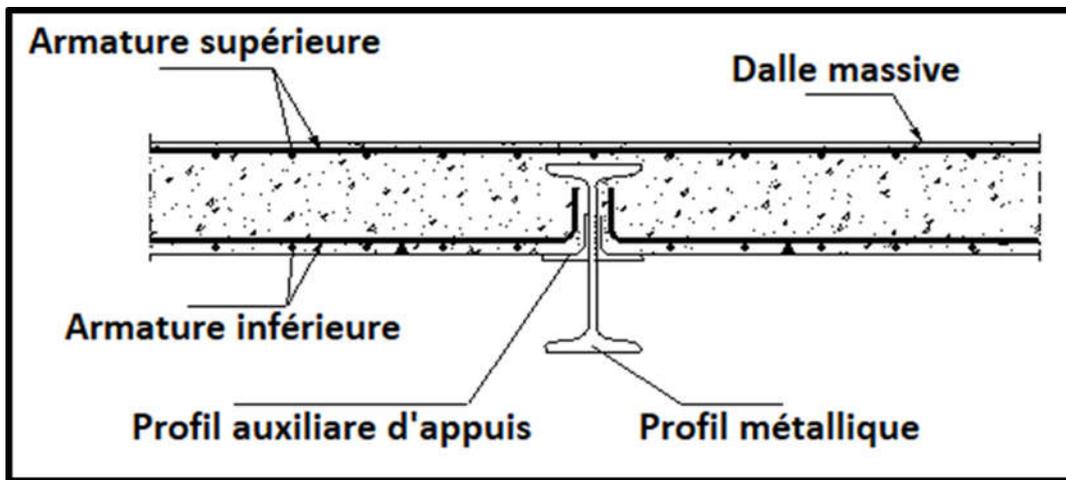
Jonction profil métallique et la dalle pleine. Source : www.detailsconstructifs.cype.fr
